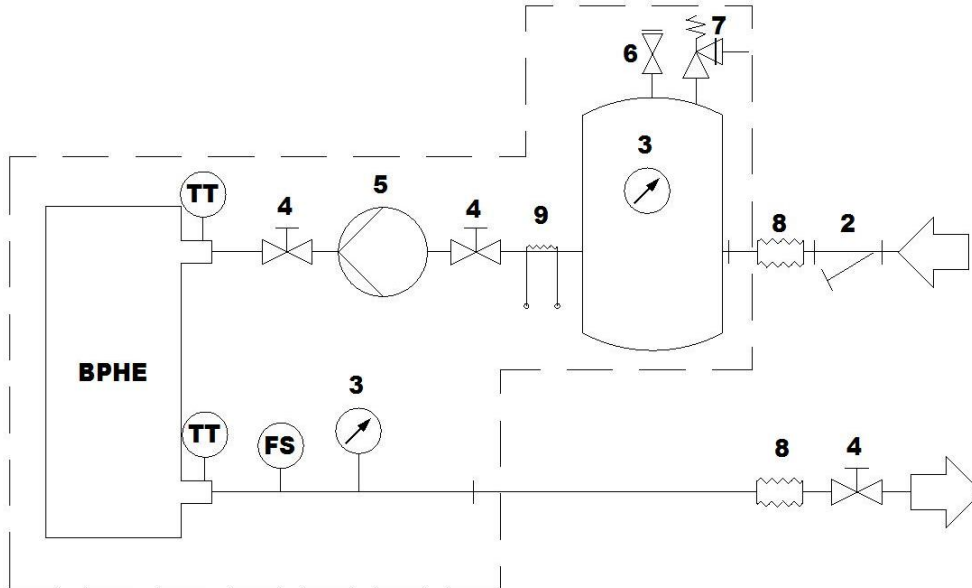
Hydraulikschemata mit Hydraulik-Bausatz (opt. 134÷137) (max. Betriebsdruck 6 bar)
